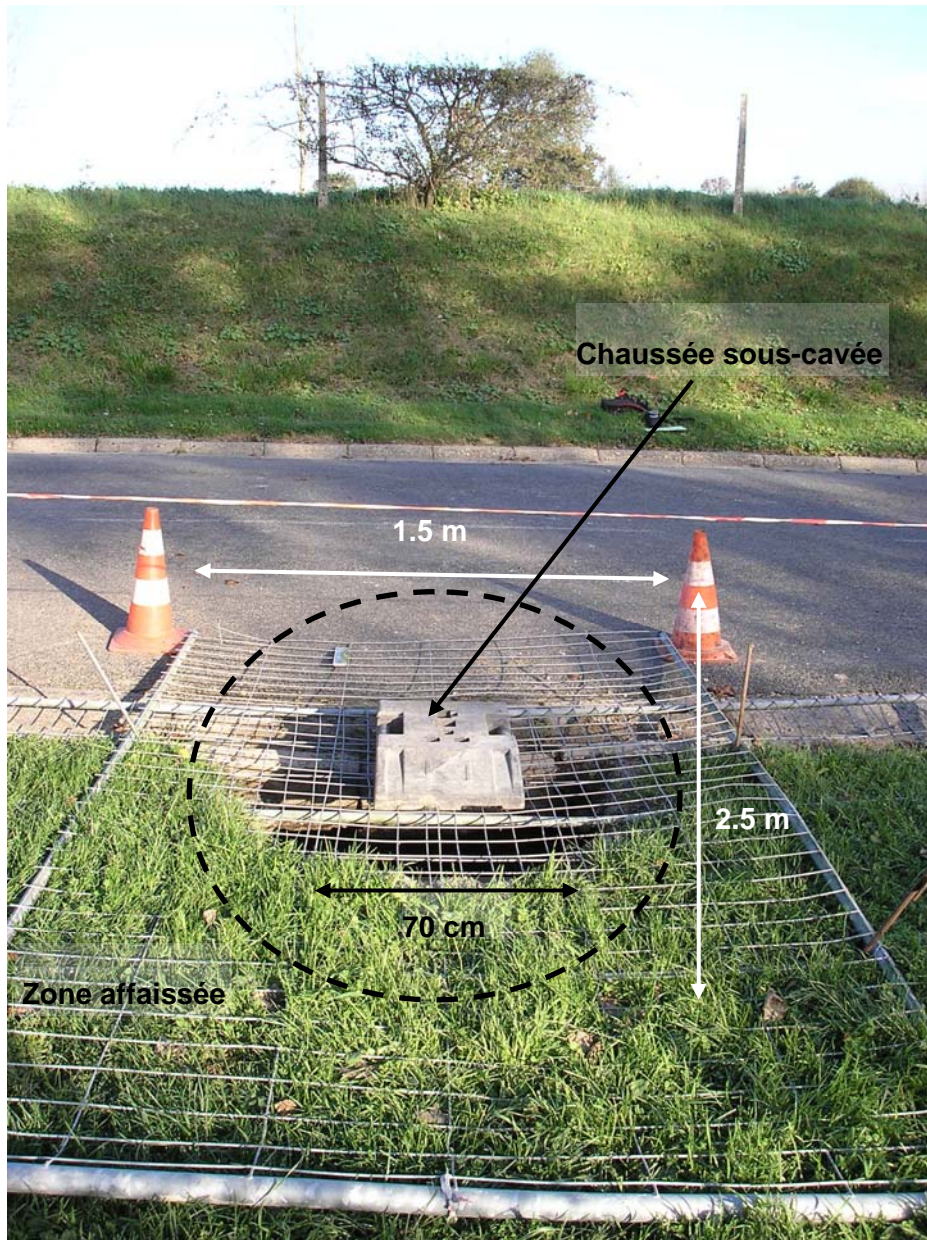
la chaussée et sa bordure ont subi des dégâts.
